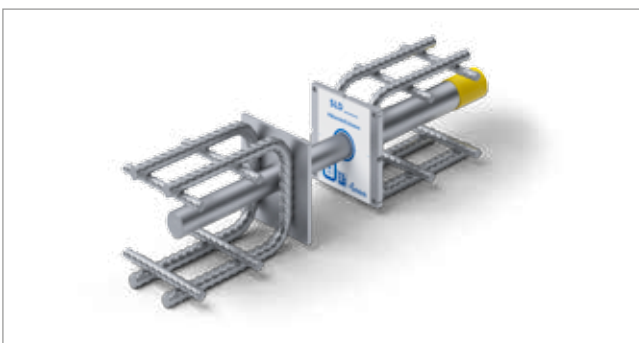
Schöck Dorn Typ SLD für hohe Lasten.
